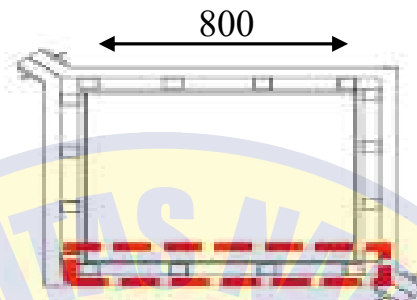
Perencanaan Desain Bekisting Kolom
